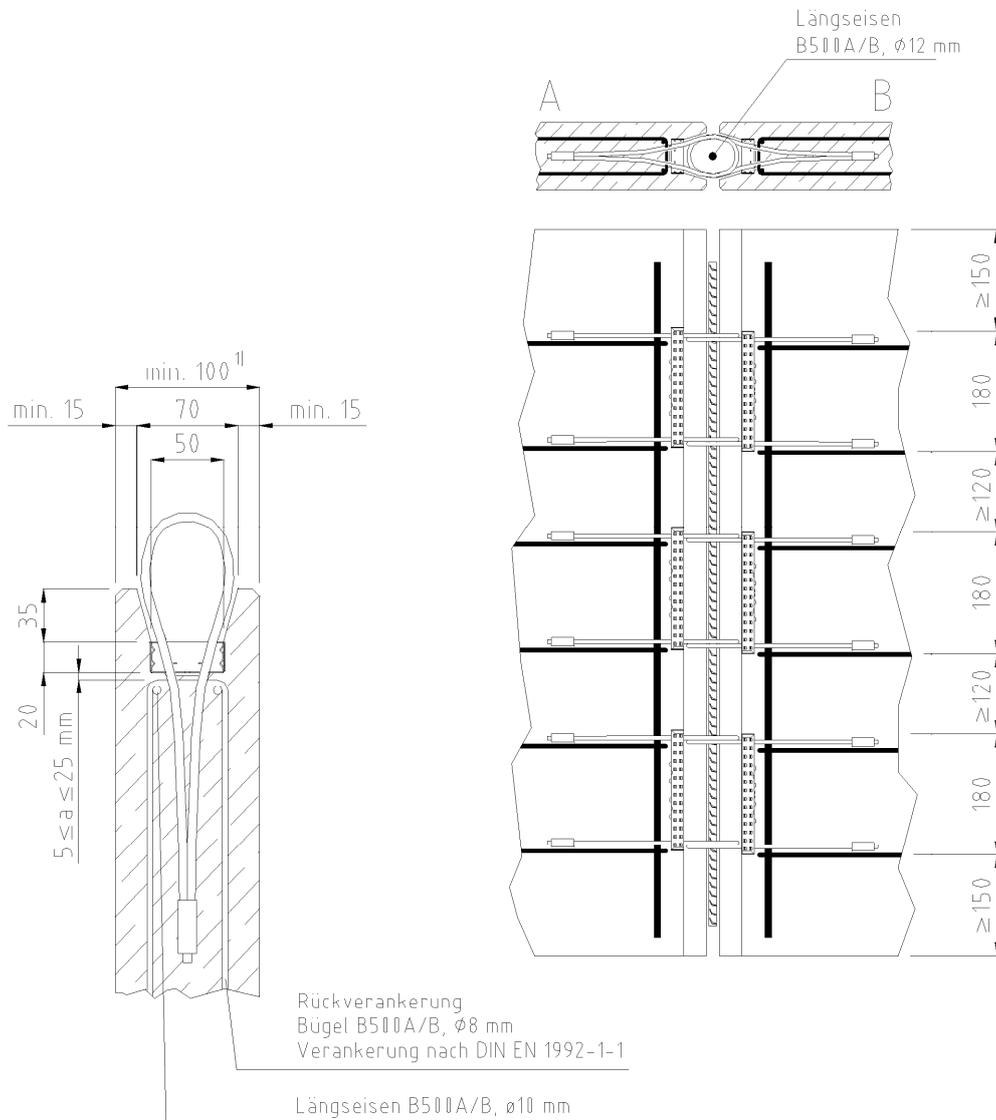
Vergussnut, Bewehrung (Detail Fertigteile A und B)
